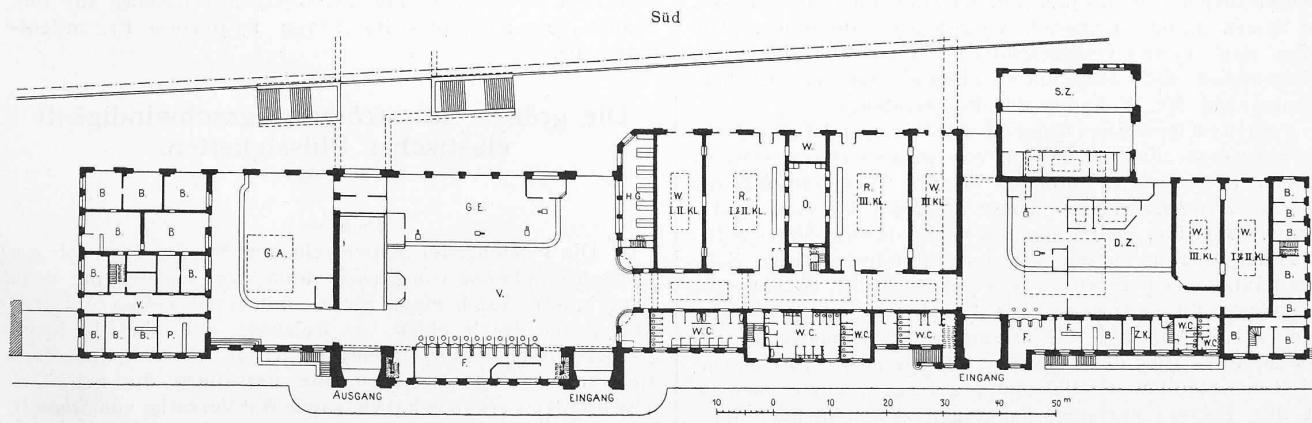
Grundriss vom Erdgeschoss. — Maßstab 1:1200.
